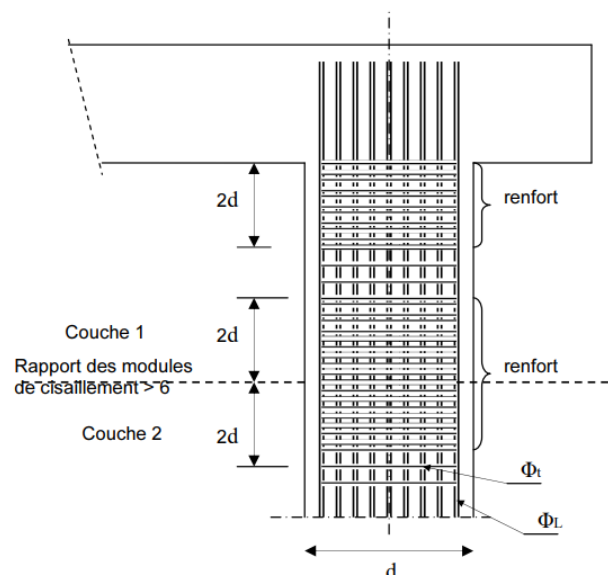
disposition des armatures longitudinalement (RPOA)
